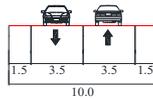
Coupe transversale typique de route du centre-ville (tertiaire, toute zone)
